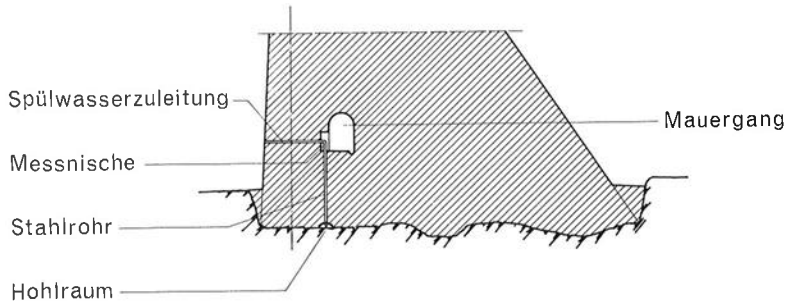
Gewichtsmauer mit Hohlräumen an der Sohle
